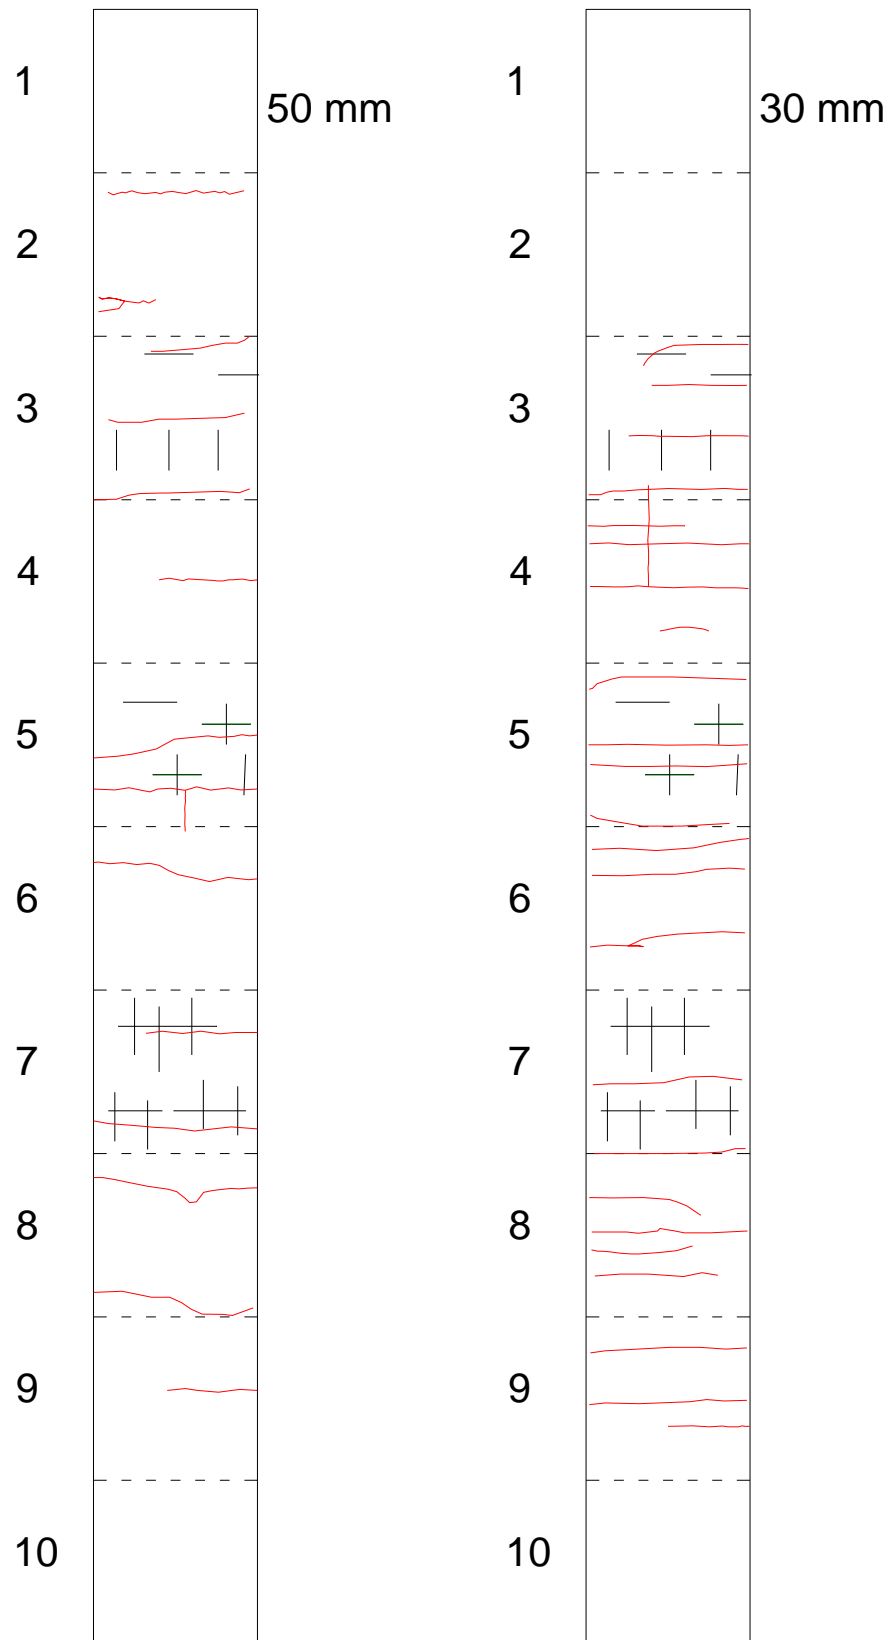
Croqui do levantamento das fissuras nos recapeamentos.
